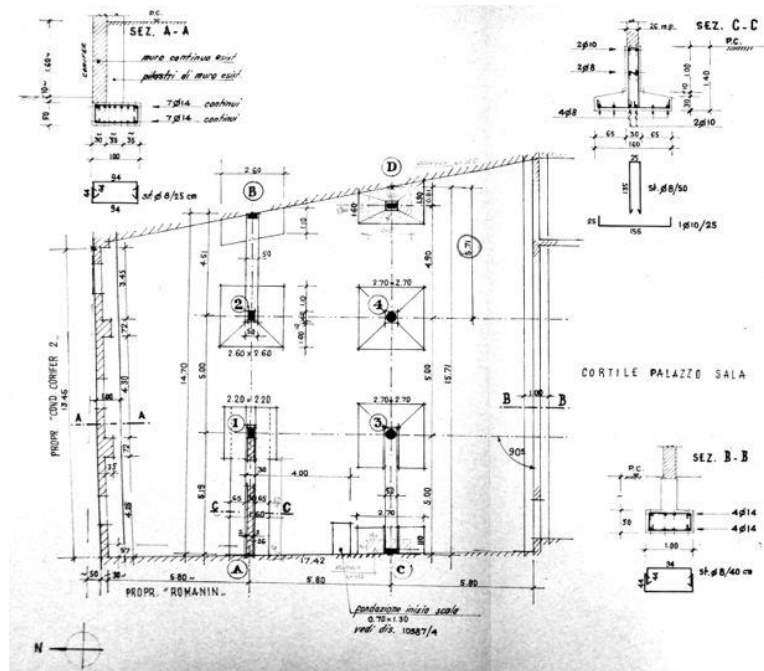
Strutturale fondazioni, 7 agosto 1973
